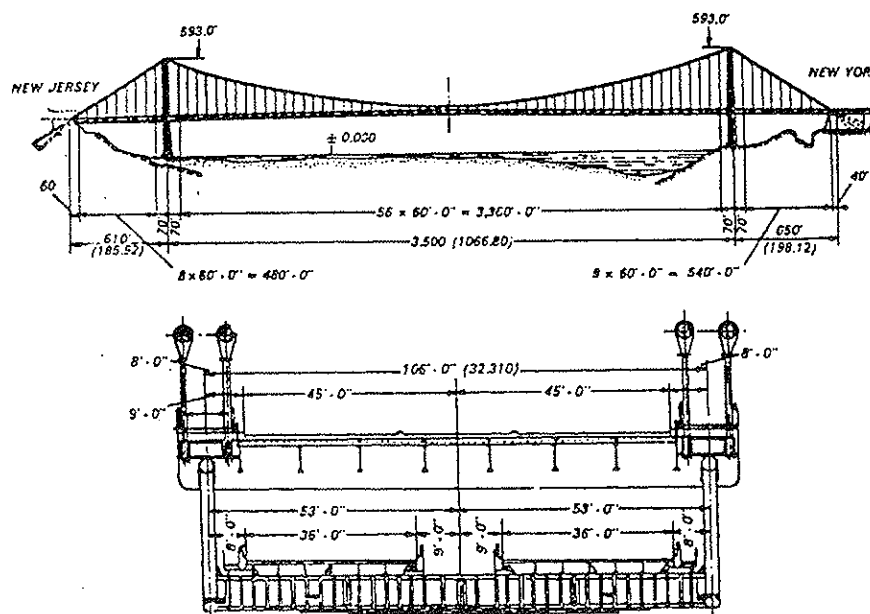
Esquema longitudinal y sección transversal (primera y segunda fase) del George Washington Bridge.
